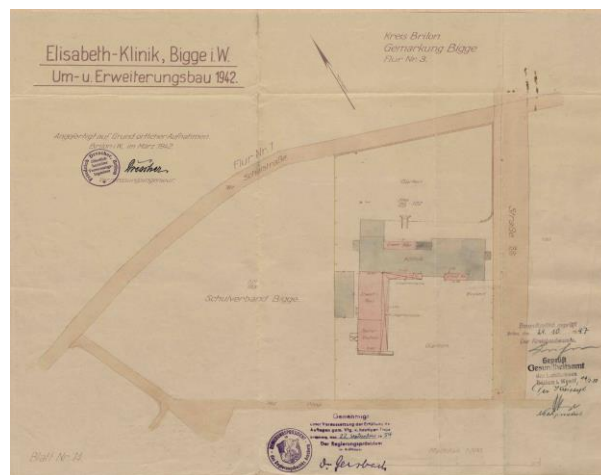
Lageplan zum Um- und Erweiterungsbau 1942
